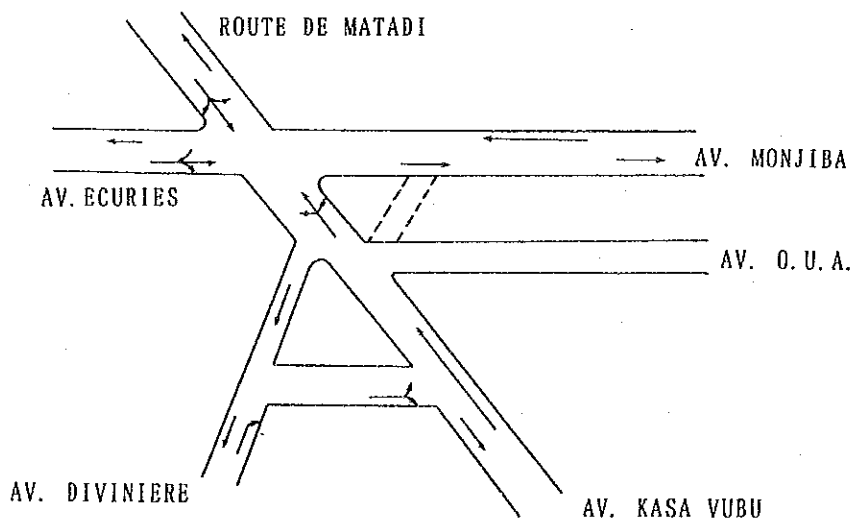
Cas 2 plan d'aménagement du carrefour
